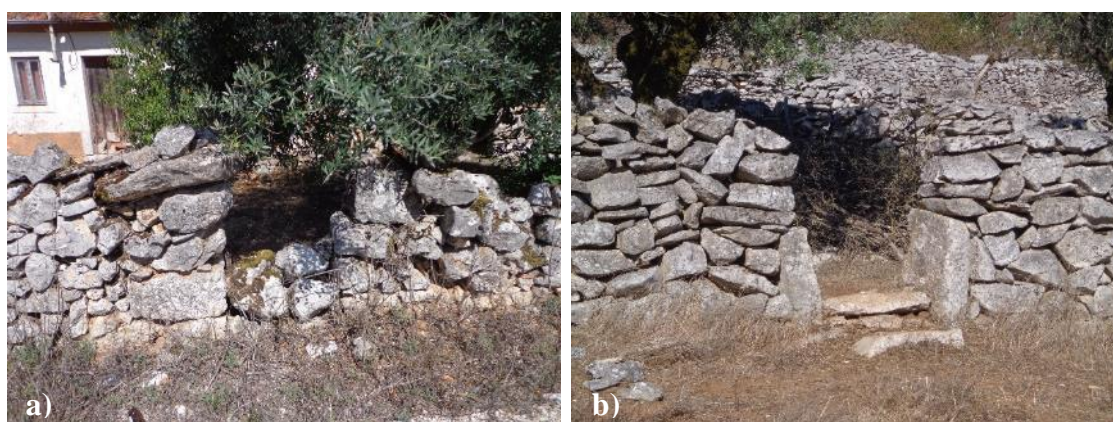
Aparelho misto de cantaria e alvenaria de pedra seca: a) e b)
